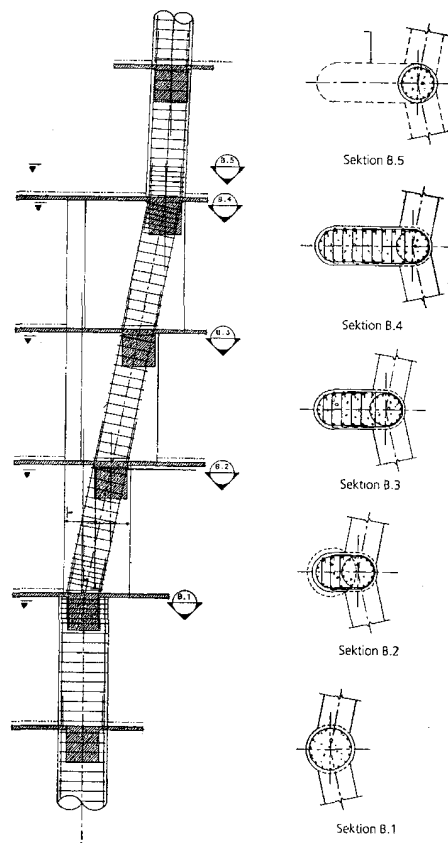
Detail vom Stützen-Rücksprung [10.24]
